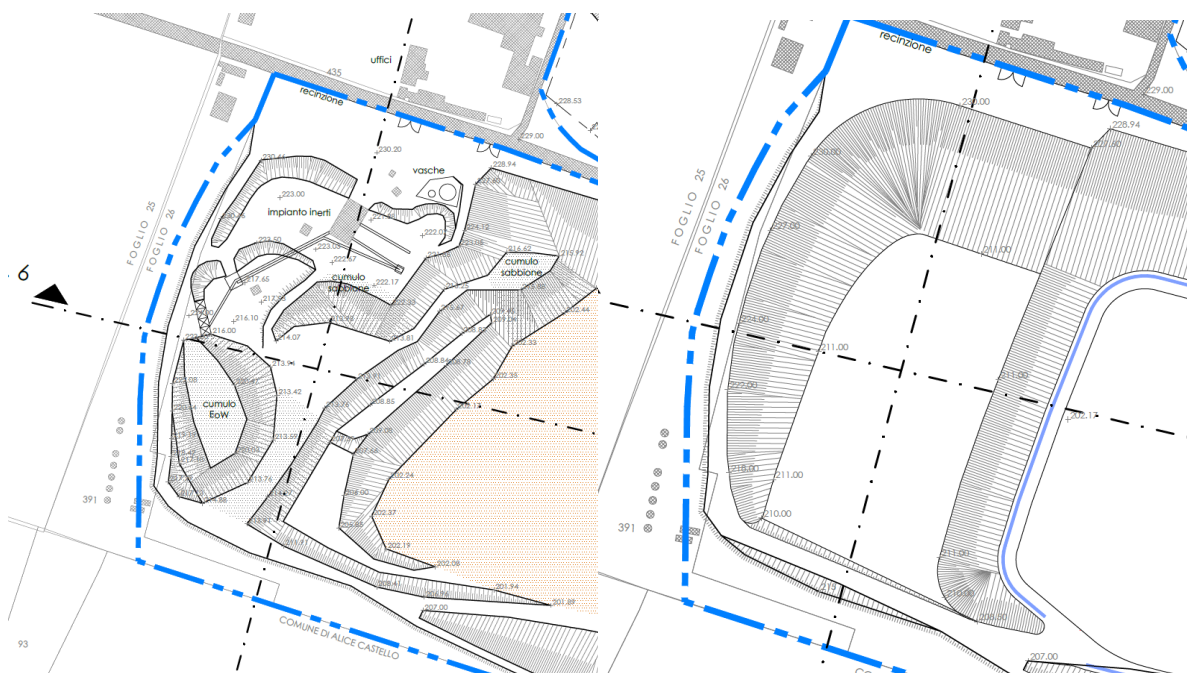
Raffronto tra lo stato di fatto – a sinistra - e quello di progetto – a destra - dell'area impianti, in stralcio alle tavole 1.3 (Stato di fatto) ed 1.4 (Planimetria di massimo scavo)
